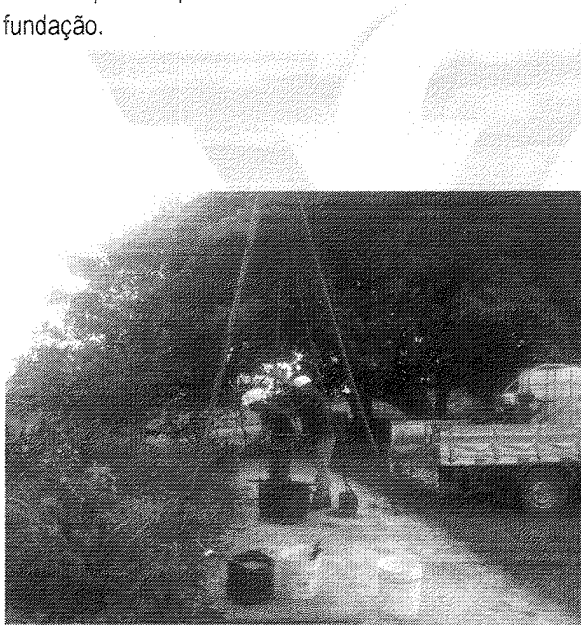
Detalhe da operação da lavagem para encontrar a cota de amostragem.
